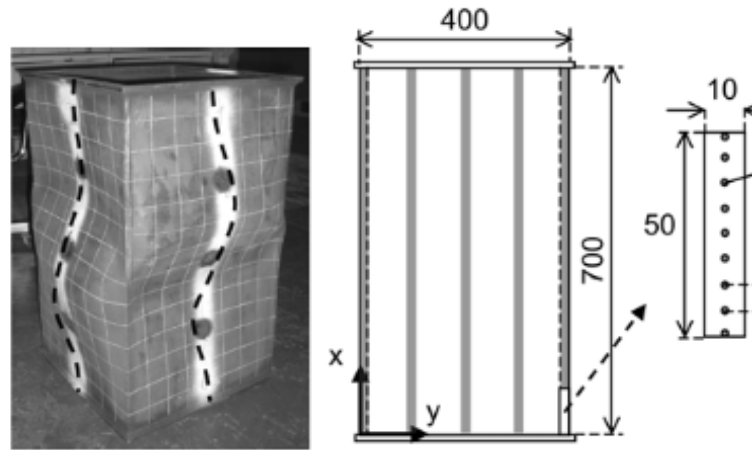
Kalıcı gerilmeler ve kalıcı geometrik kusurlar [6]
